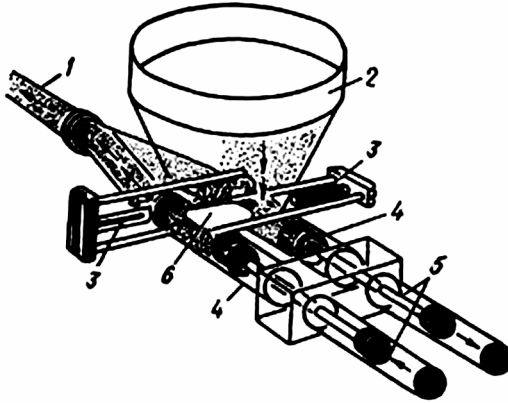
Схема роботи бетононасоса з гідравлічним приводом:
